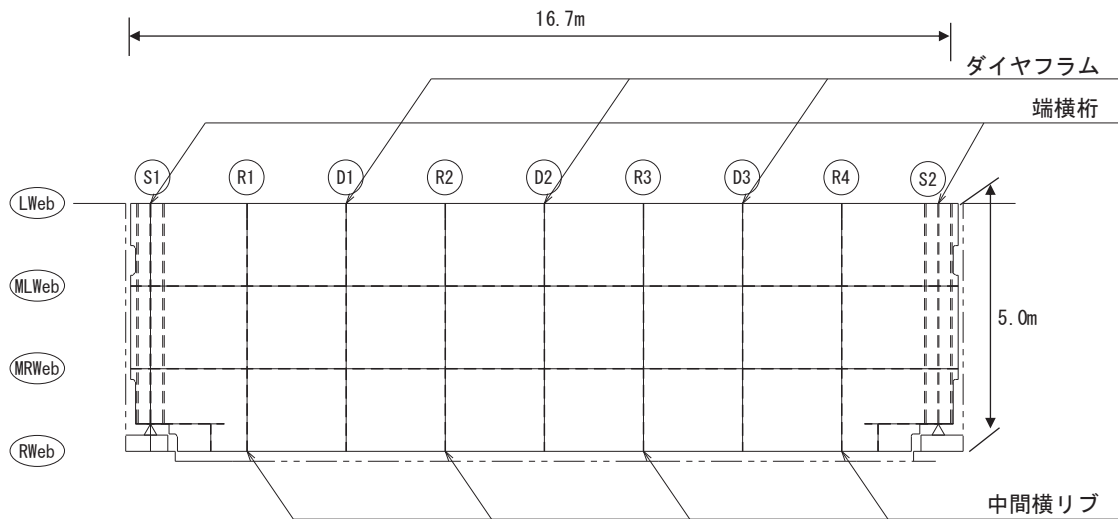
(2) 鋼製遮水壁（鋼桁 2） 平面図
